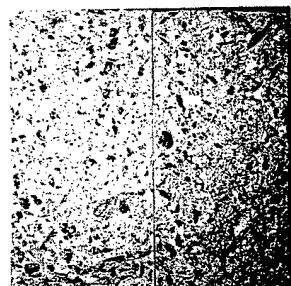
バイブルーティを用いた高流動コンクリート供試体の割裂破断面
